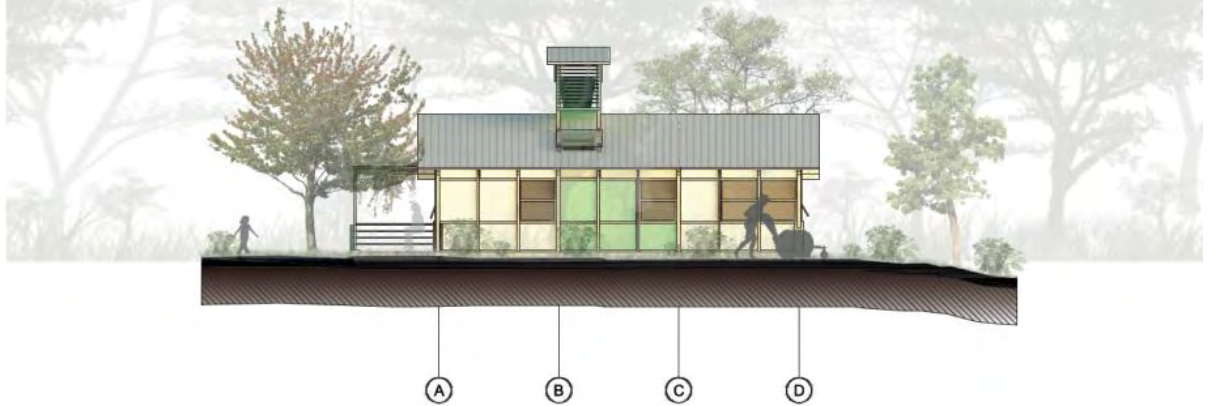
Fachada 03, alzado Oeste BI Fuente: propia
